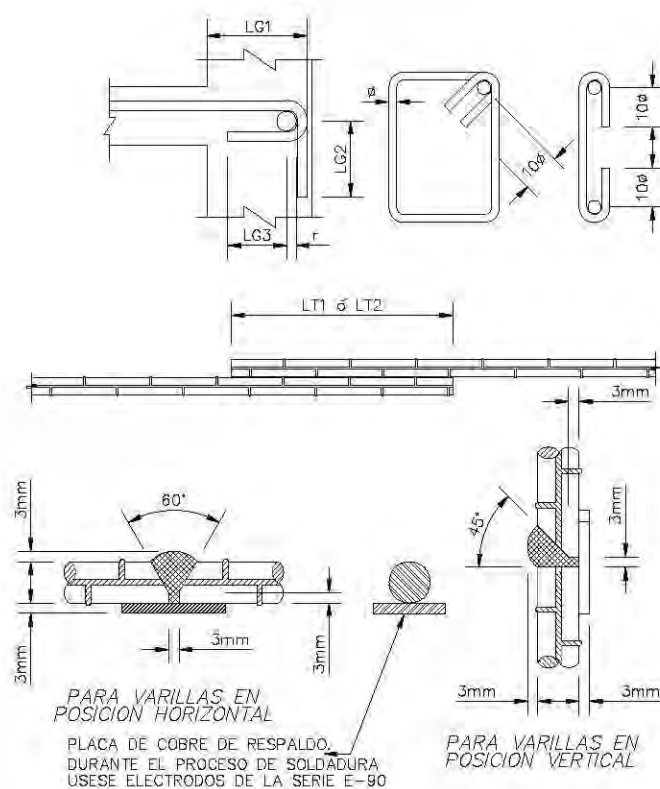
Detallado de ganchos, traslapes y conexiones soldadas en acero de refuerzo
